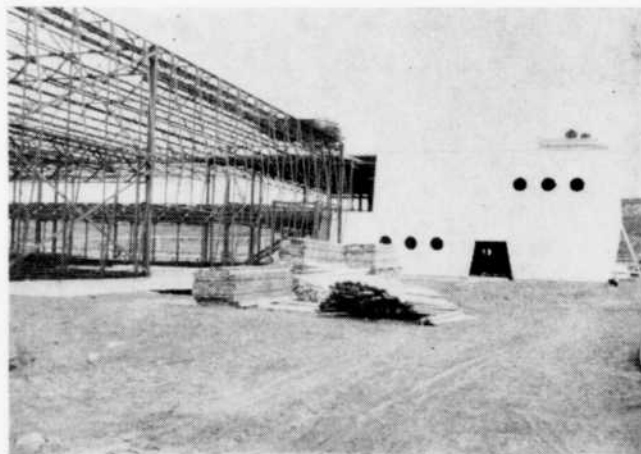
Des ailerons fixes construits d'une structure légère en acier furent placés verticalement afin de supporter les panneaux muraux ainsi que les poutrelles ajourées formant la structure du plancher et du toit.
